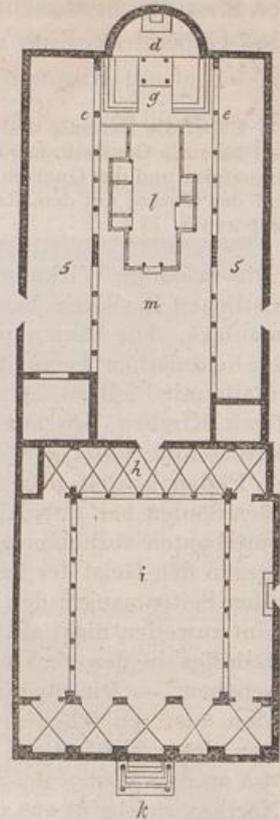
Grundriss von S. Clemente in Rom (nach d'Agincourt).
